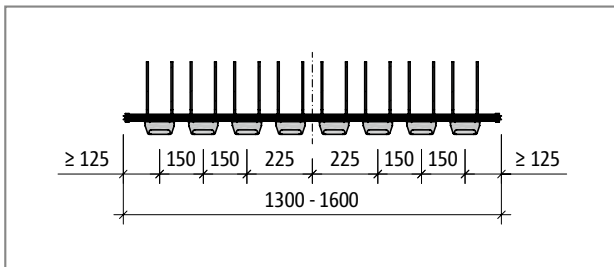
Schöck Tronsole® tipo T-V8-H...-L1300 - L1600, pianta del prodotto
